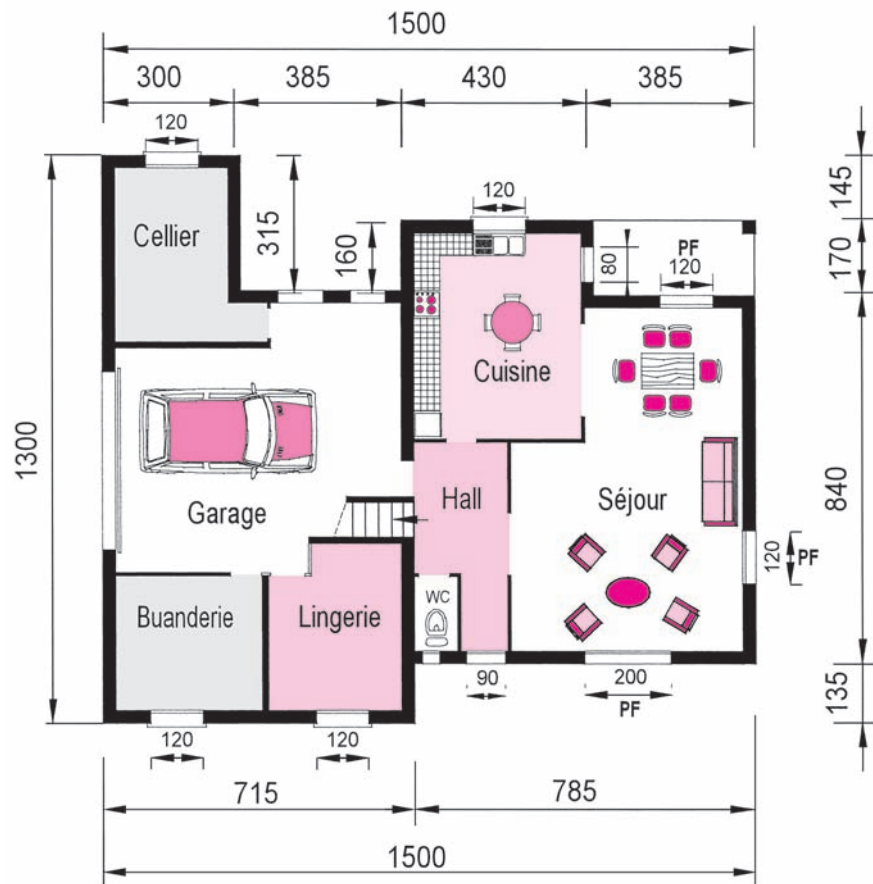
Schéma de principe d'avant-projet du rez-de-chaussée
